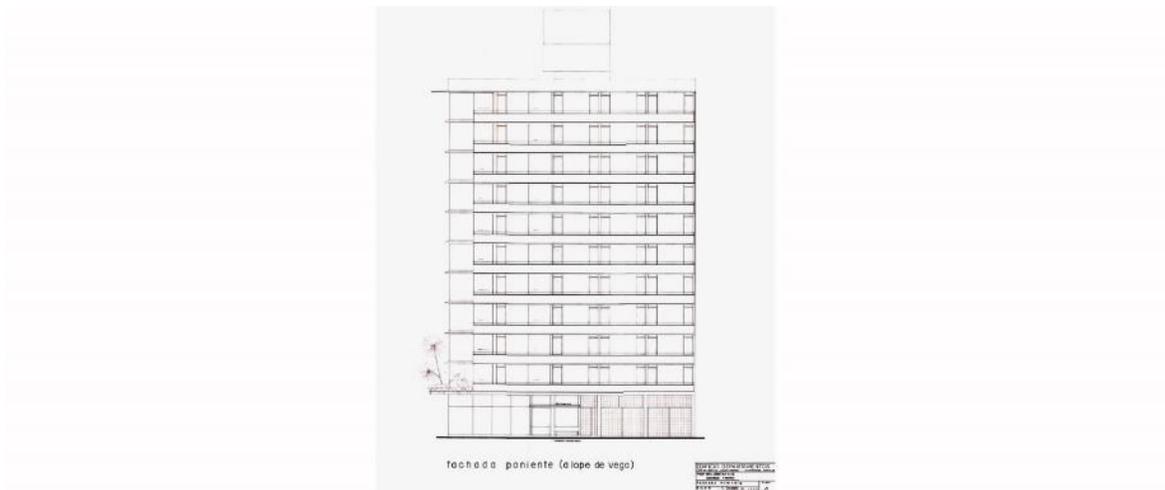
Plano fachada Lope de Vega del edificio ubicado en Lope de Vega núm. 304, 1968
